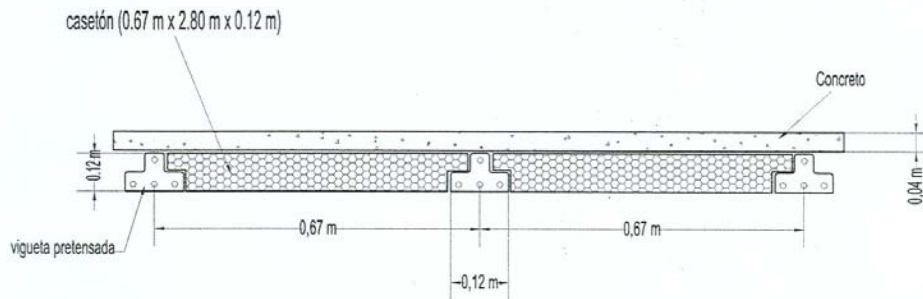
Esquema de losa de vigueta y bovedilla.
